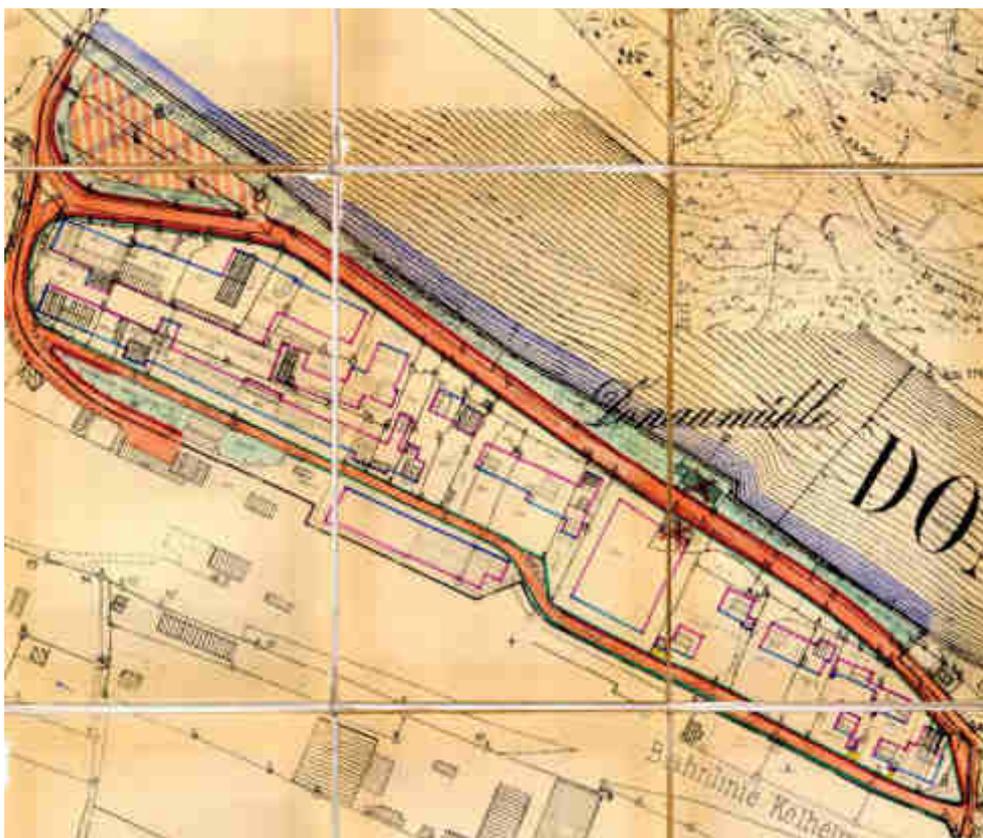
Ausschnitt Bebauungsplan Donaumühle
